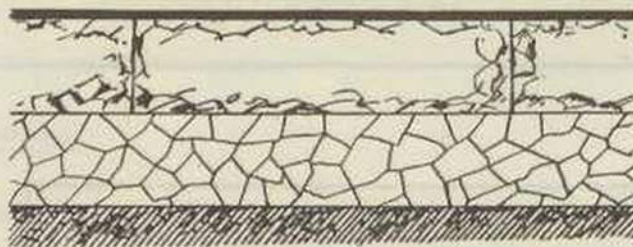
Vista em corte transversal e longitudinal da primeira via férrea.
